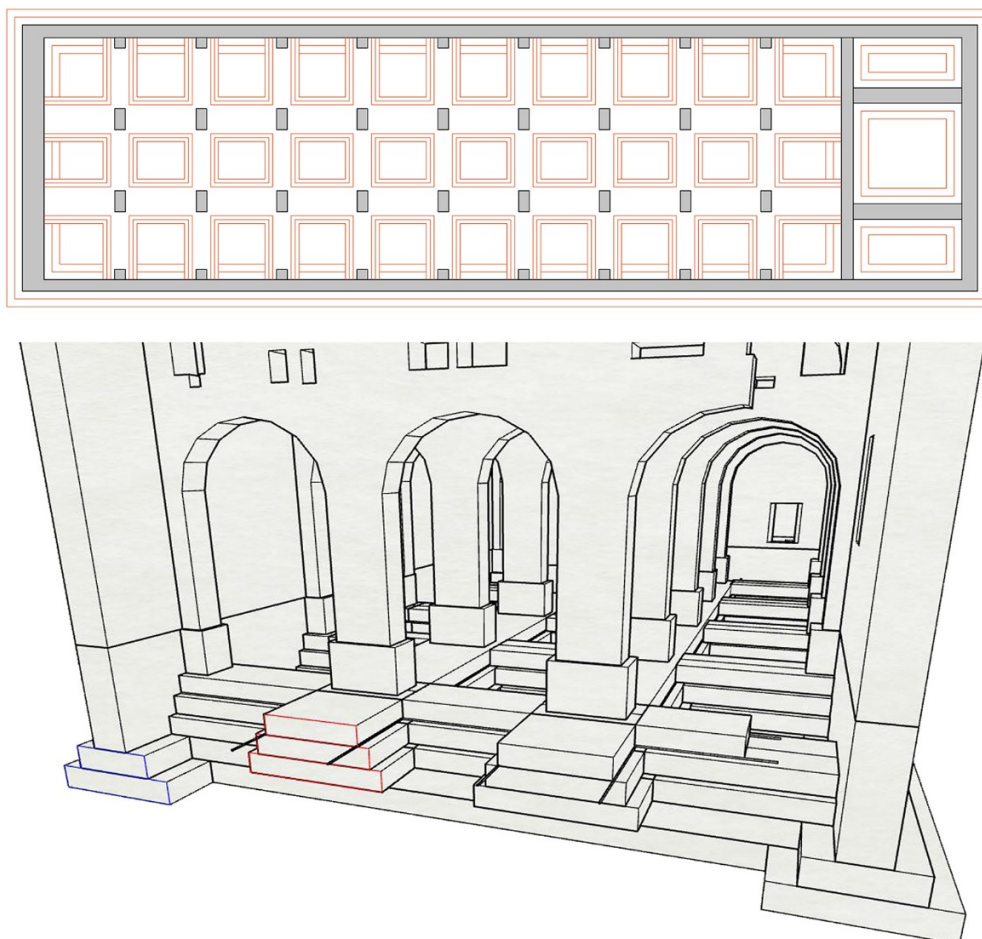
Proposta di consolidamento delle fondazioni tramite sottomurazioni, individuazione intervento e spaccato assonometrico.
